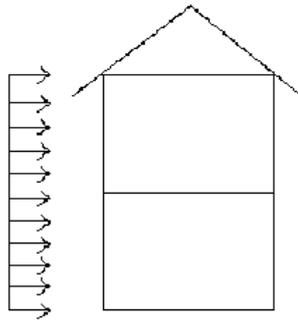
Esfuerzo provocado por el viento en la estructura.
